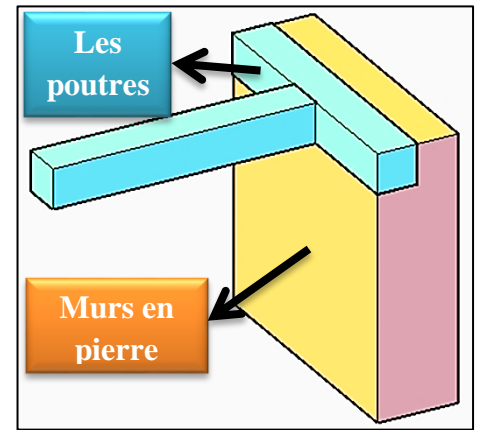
schéma d'un mur en pierre. Source : Auteur.
